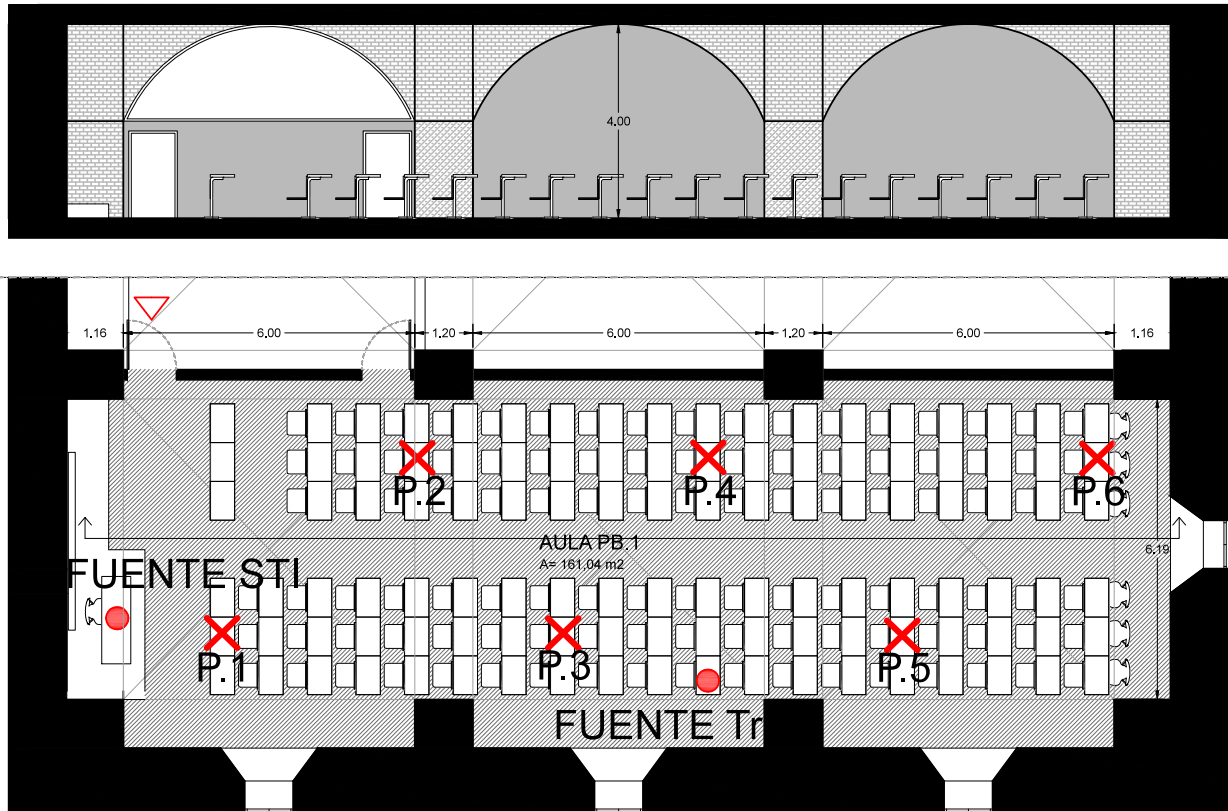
Planta y alzado del aula PB.1 de la ETSIT.
